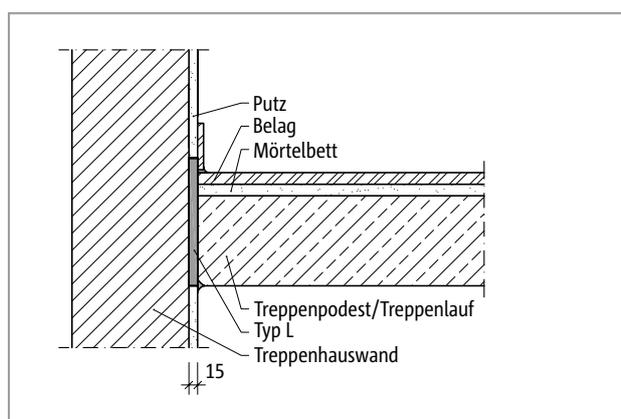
Schöck Tronsole® Typ L: Brandschutzausführung
